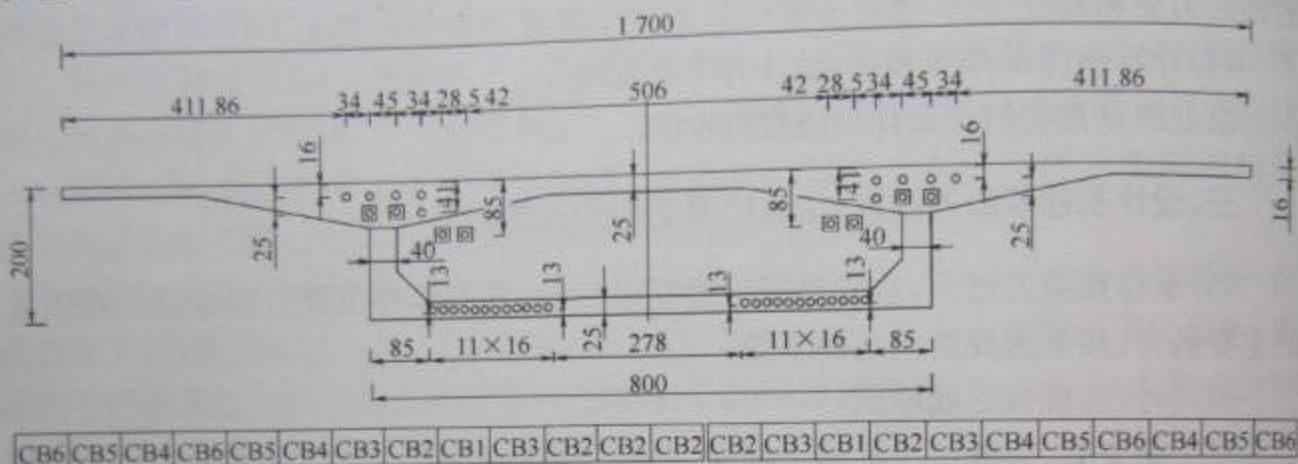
某桥跨中横截面布置图(尺寸单位:cm)
